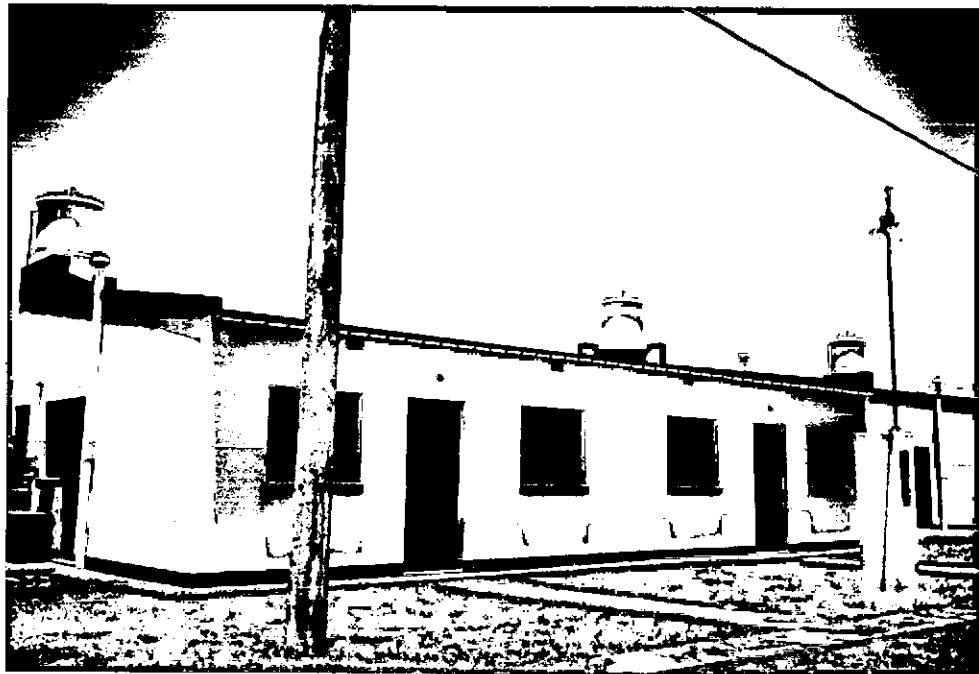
Ciudad Pampa del Indio. Viviendas construidas a través del Instituto Provincial de Desarrollo Urbano y Vivienda.
